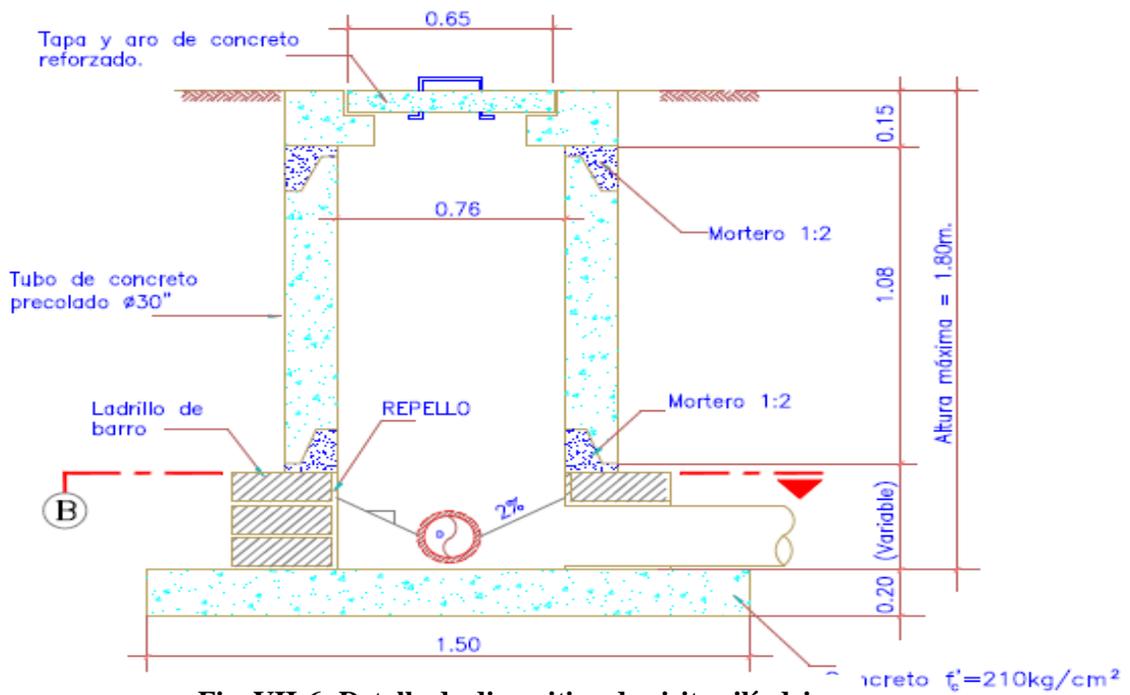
Detalle de dispositivo de visita cilíndrico (DVC)
